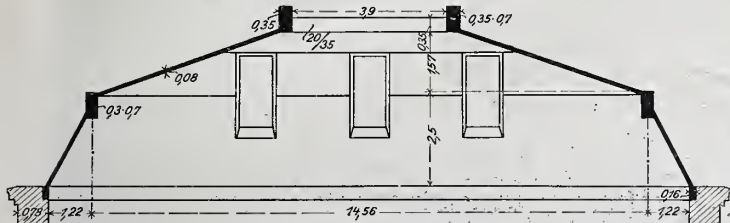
Decke über dem Bühnenraum im Dachgeschoß.
